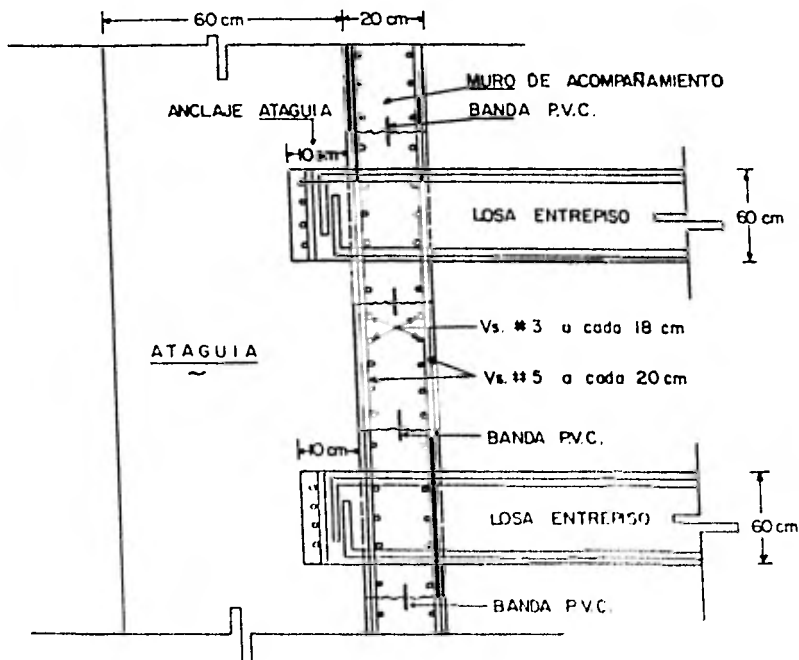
ARMADO MURO DE ACOMPAÑAMIENTO
